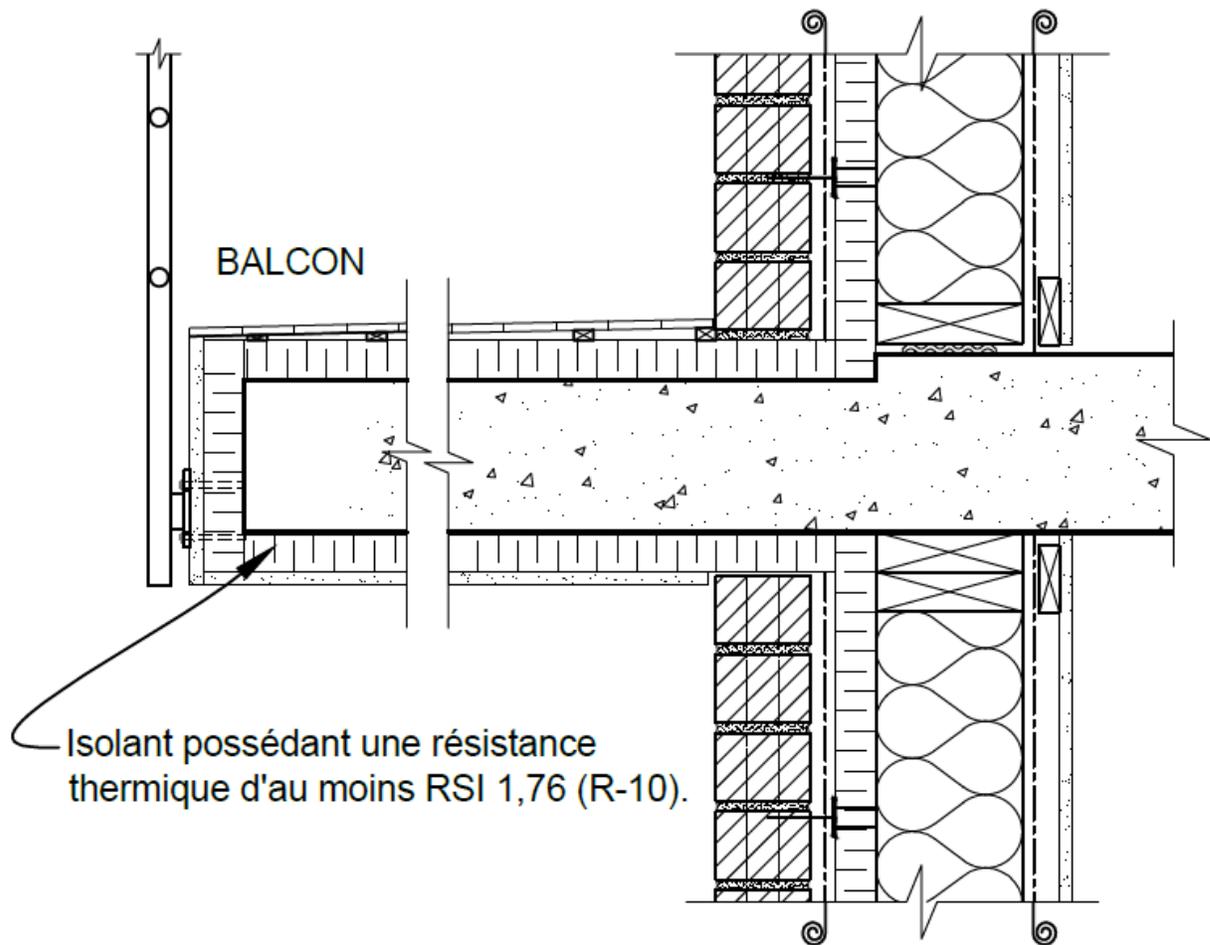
1 : Continuité de l'isolation pour une dalle structurale en béton – Méthode c)
